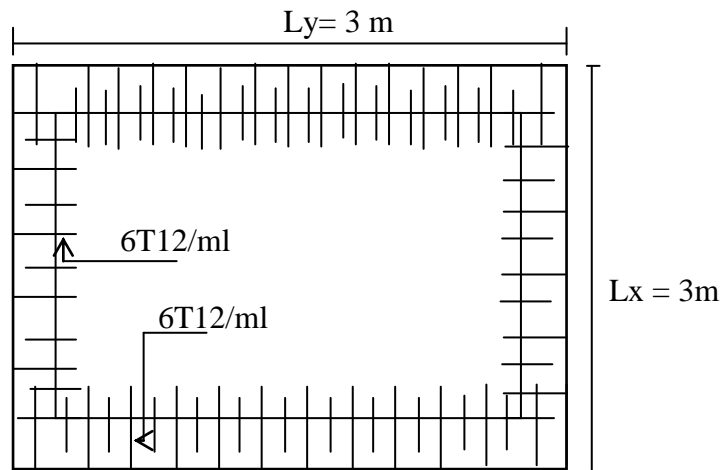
Schéma Ferrailage Supérieur du panneau de la dalle pleine.
